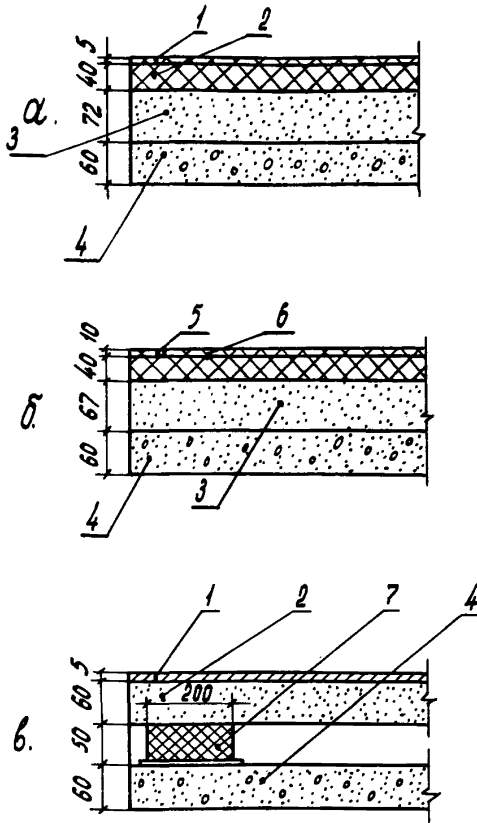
Звуконзоляция перекрытий в домах серии ИГ-480:
